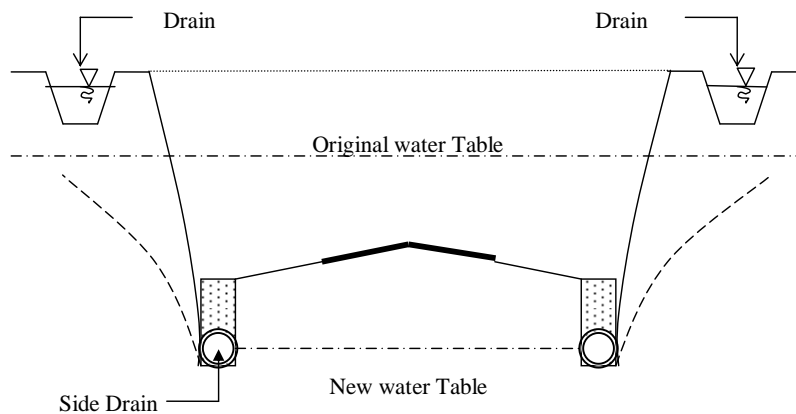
Denah System of LATERAL & LONGITUDINAL DRAINS
